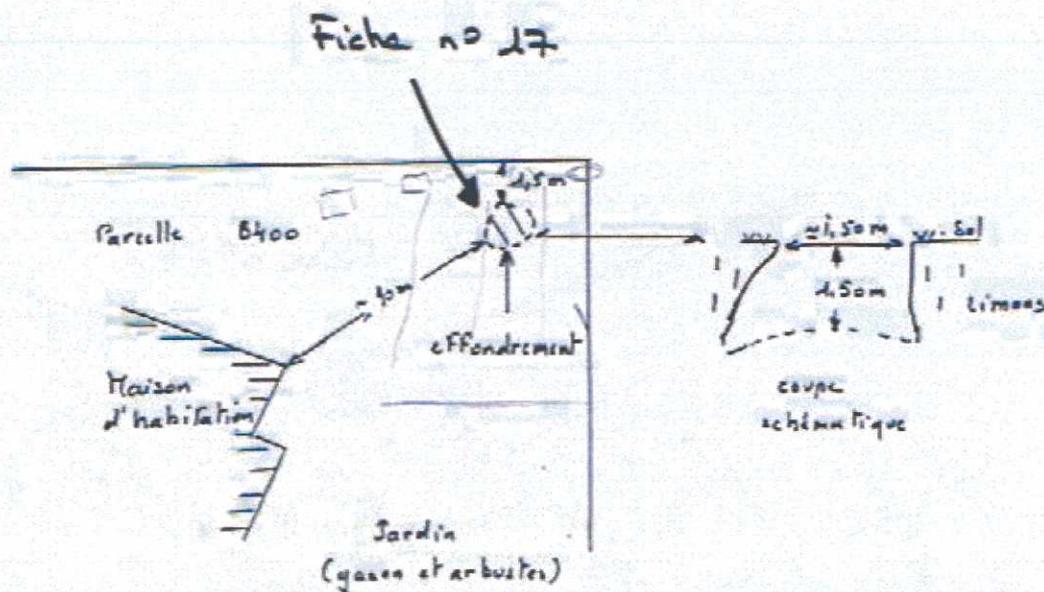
Plan et coupe schématiques de l'effondrement.
